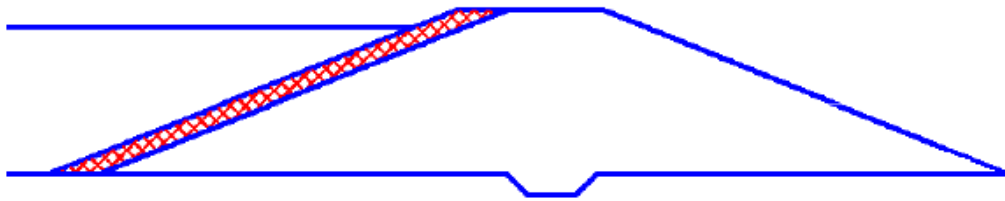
Detalle de impermeabilización sobre el talud de la balsa [35].
